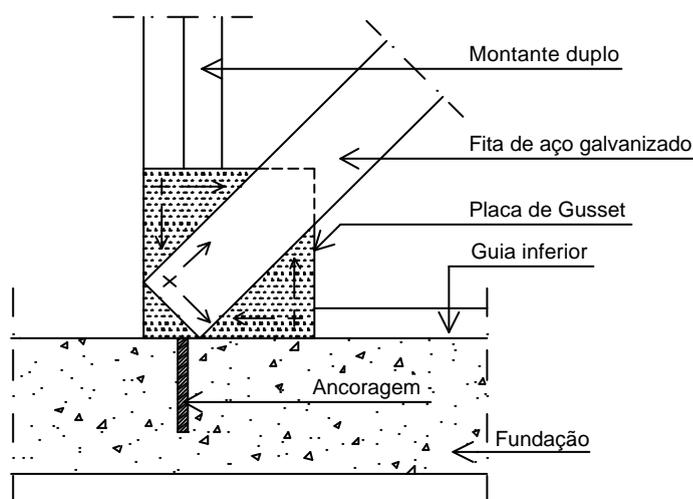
Fixação das diagonais nos painéis por placa de Gusset.
